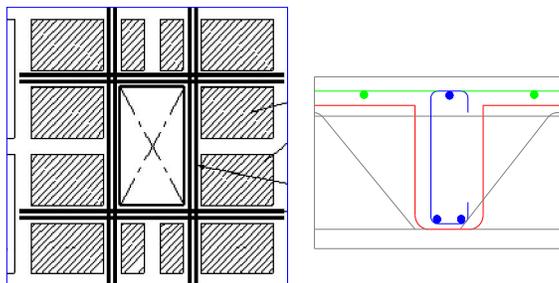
Detalhe armadura transversal das nervuras de travamento. Fonte: arquivo do autor.
